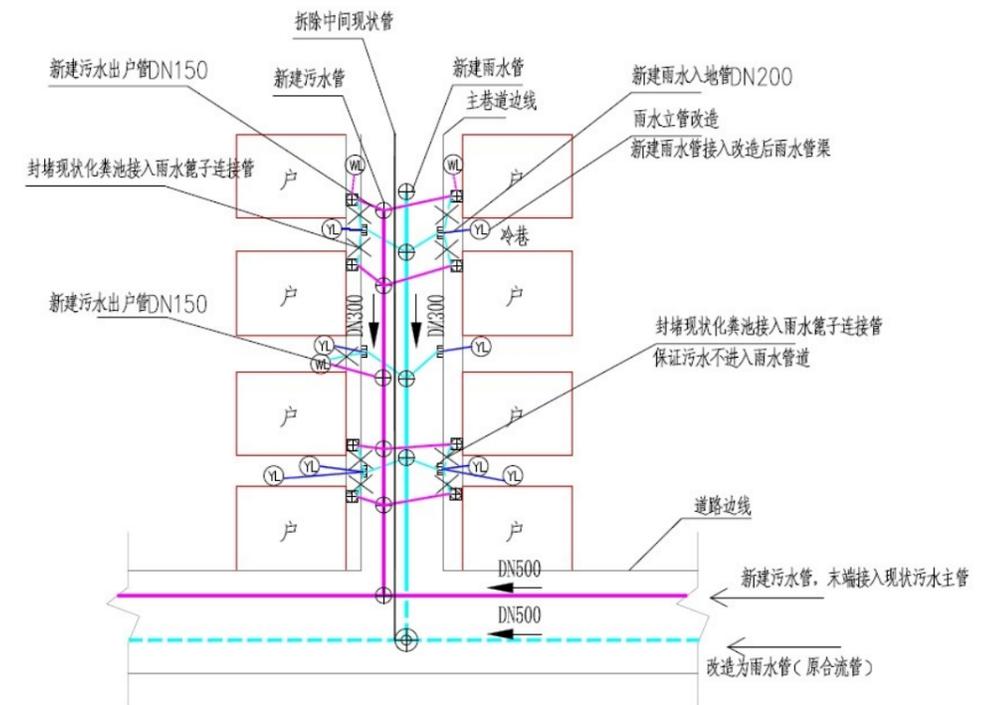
主巷（1~2.5 米）排水改造平面示意图（二）
